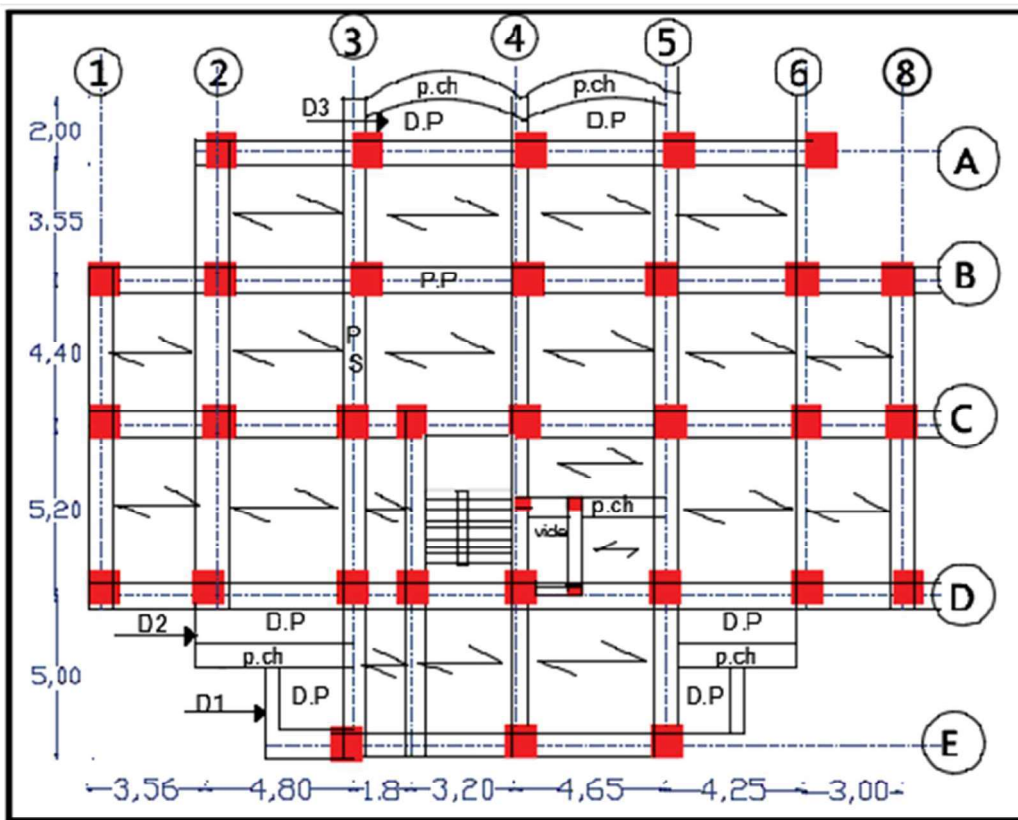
Plan de disposition des poutrelles (étage 1)
